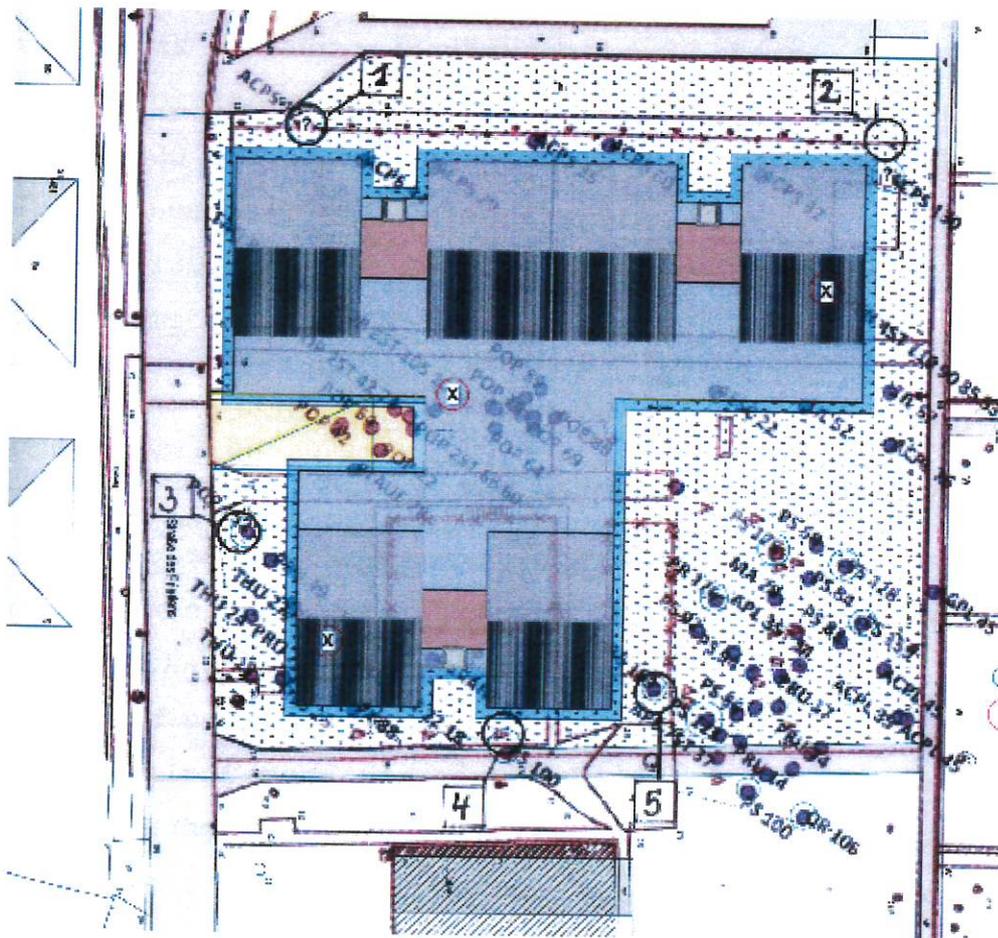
unbemaßter Lageplan mit blau markiertem Baugrubenrand und Baumstandorten 1 bis 5
